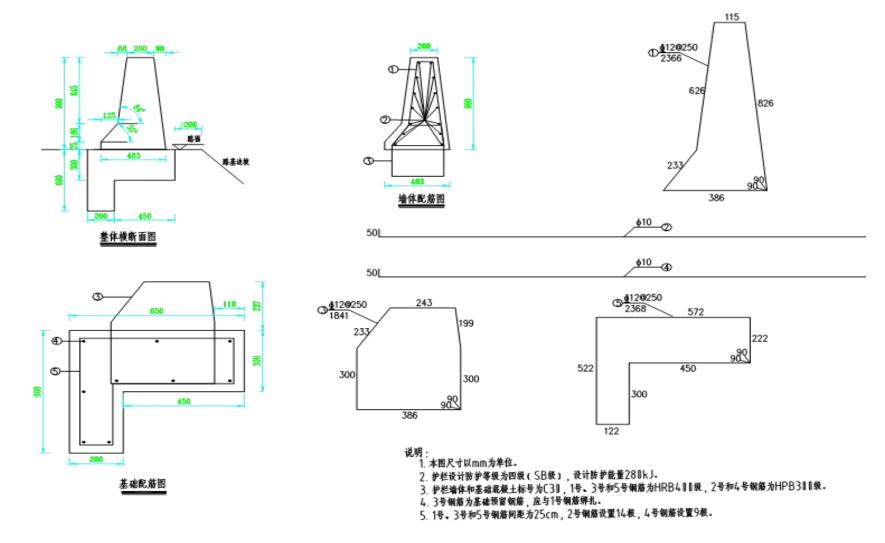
四(SB)级 F 型路基混凝土护栏设计示例(尺寸单位: mm)
